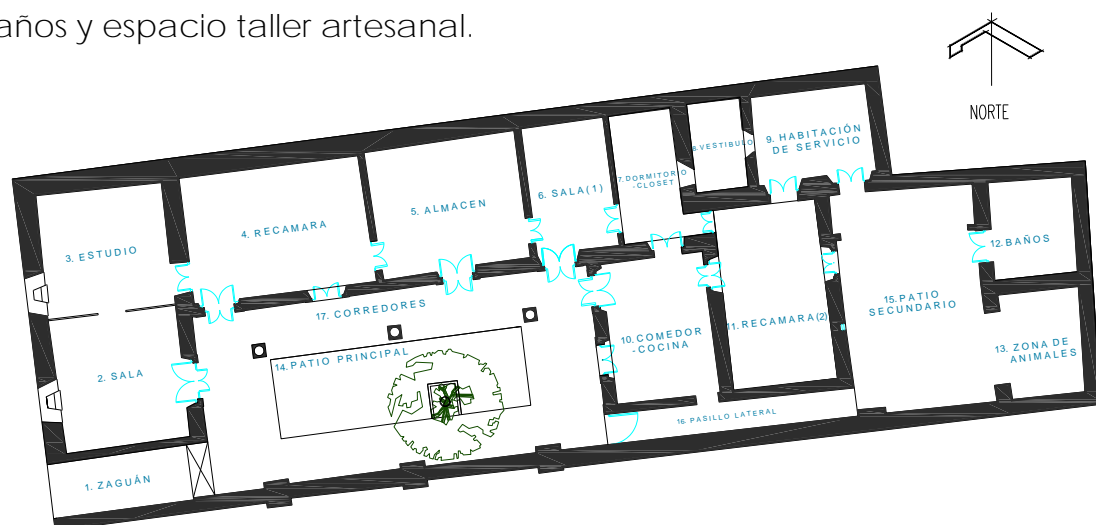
Planta arquitectónica de uso actual de los espacios del inmueble.
